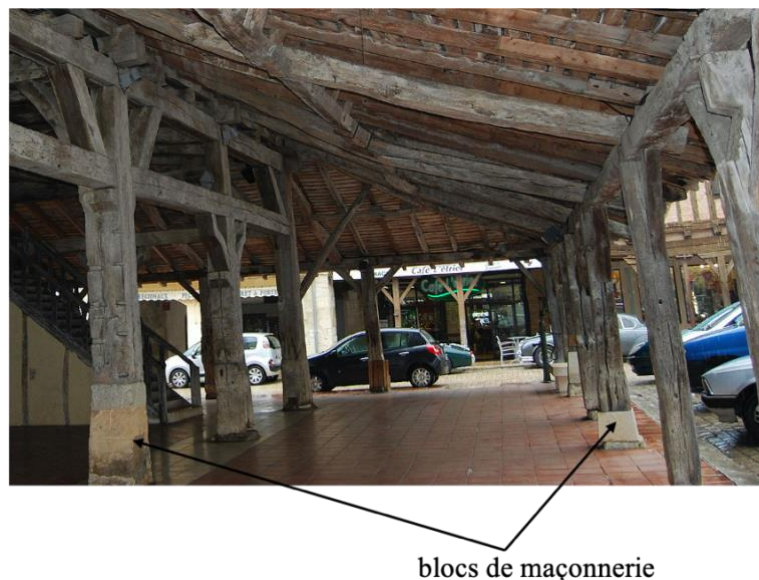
Poteaux de la halle avec à leur base les blocs de maçonnerie
